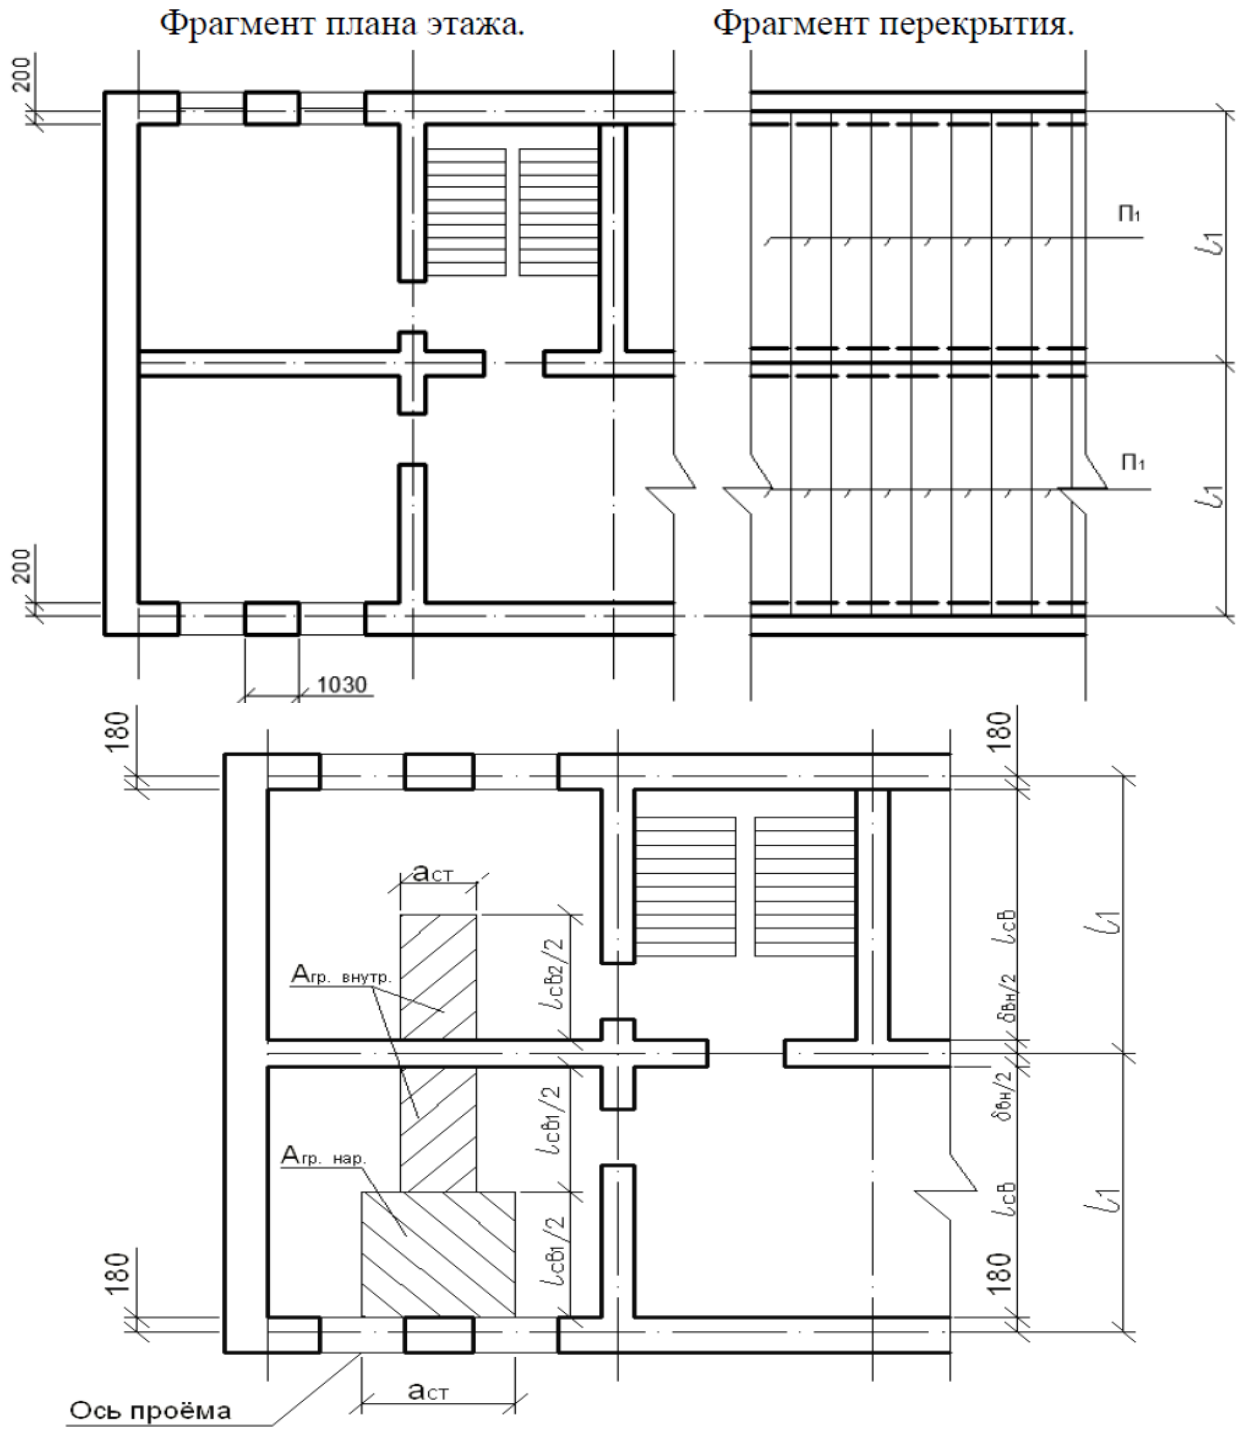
Схема определения грузовой площади для сбора нагрузок для зданий с несущими продольными стенами:
